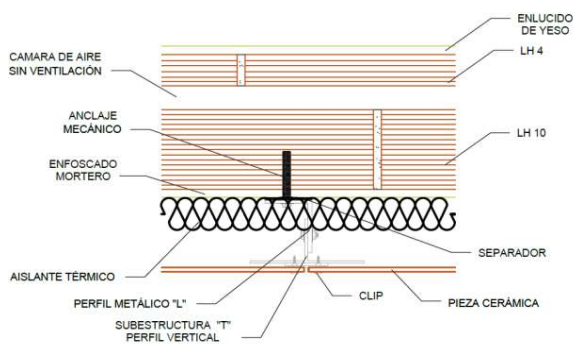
Detalle fachada tramo recto, (Fuente: autor)
